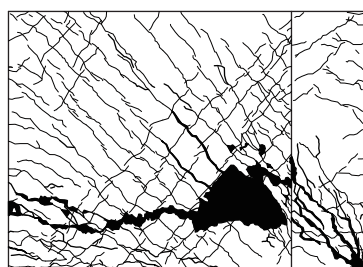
最終ひび割れ状況－A' タイプ
